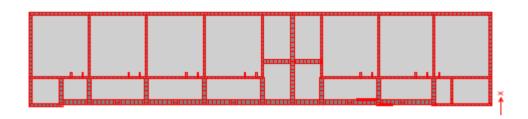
Planta segundo piso, Colegio Madres Domínicas Edificio 2.
